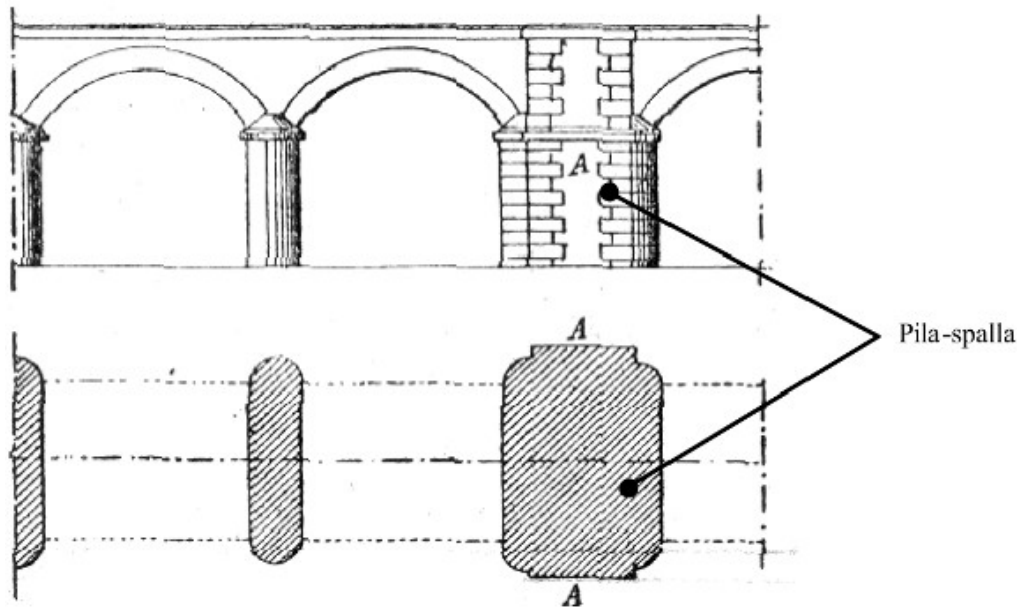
Pila-spalla (Baggi, 1926).
